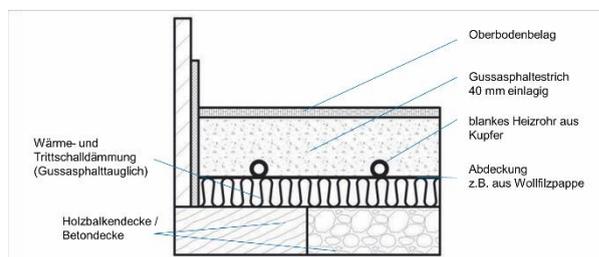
Bodenaufbau nach Bauart A mit Gussasphaltestrich
